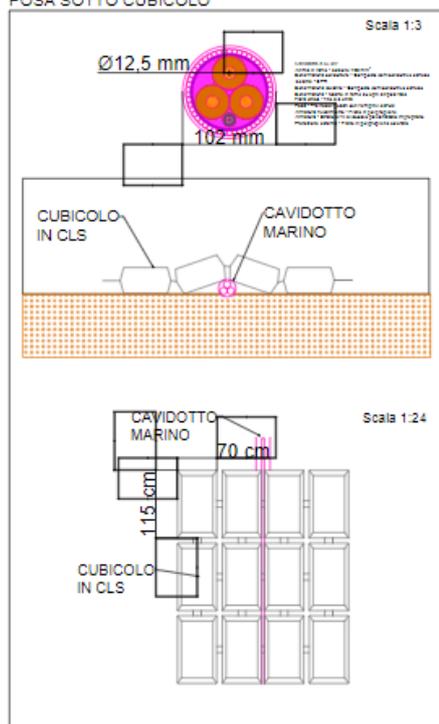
Esempio di cavo di collegamento a 66 kV e tipici di sezione
